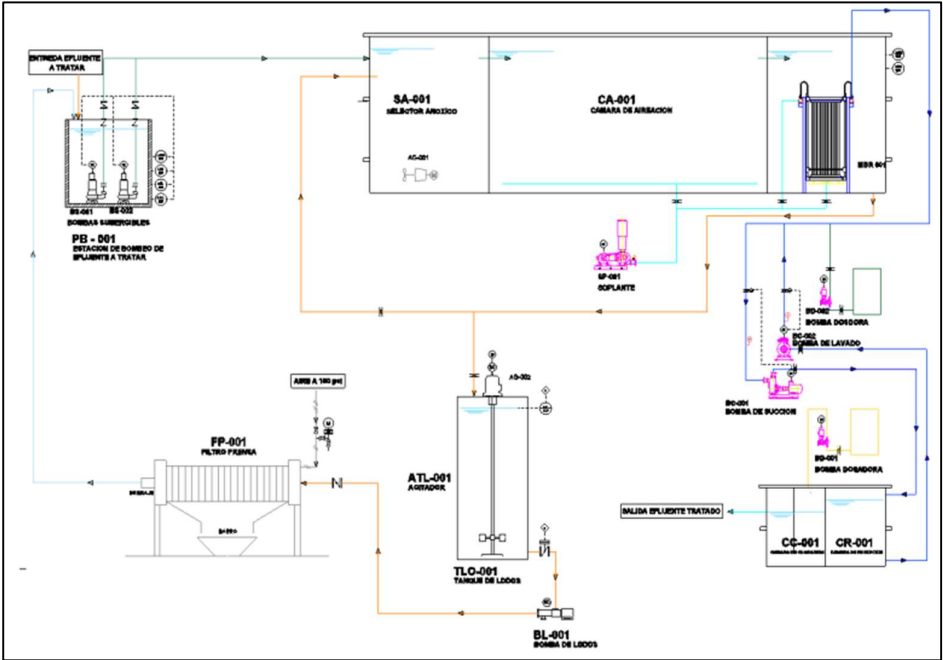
P&ID "Revamping Planta de Tratamiento de Planta Cloacal".
